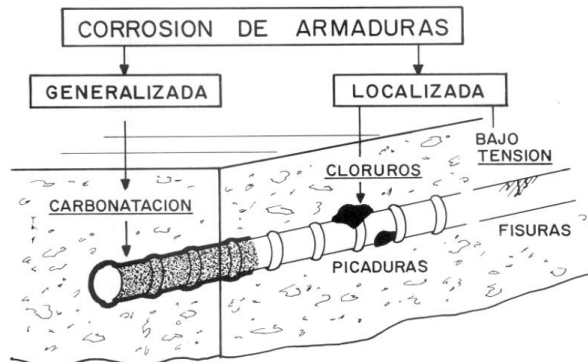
Corrosión localizada y generalizada en armaduras en hormigón armado
